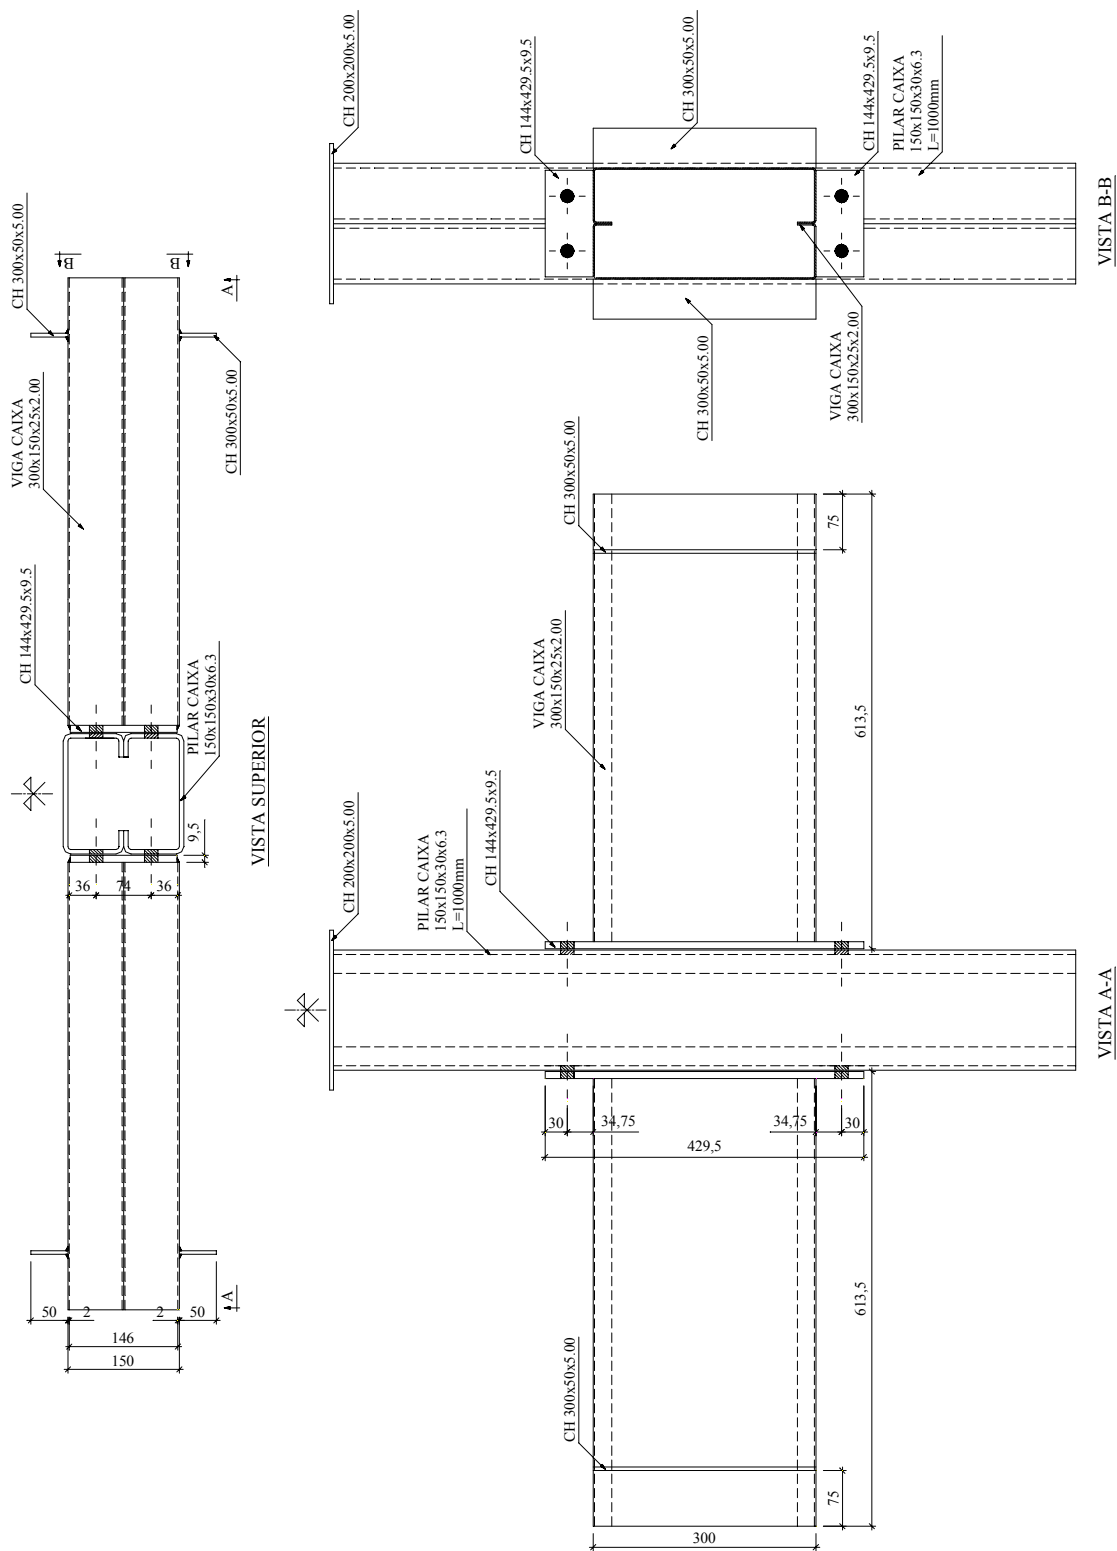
Ligação 04BF: flexível na maior inércia do pilar.
